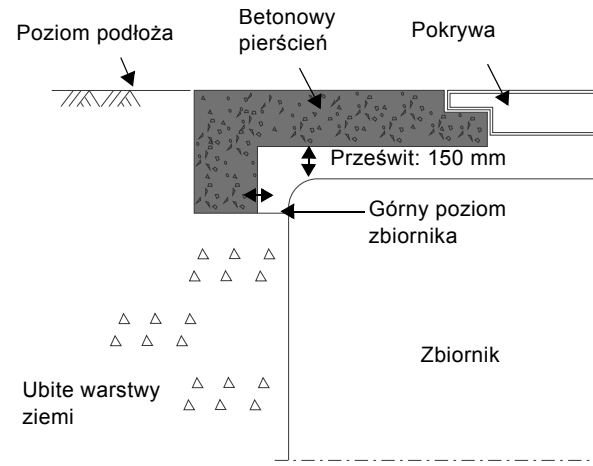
Montaż pokrywy z betonowym pierścieniem
